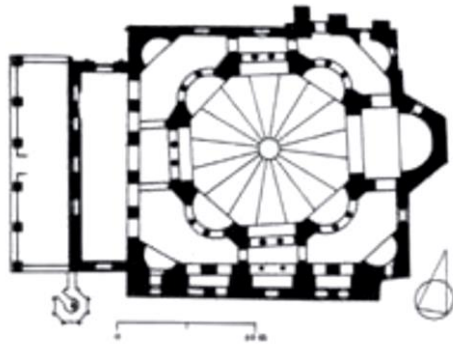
المسقط الأفقي لكنيسة سان جورج عن:
